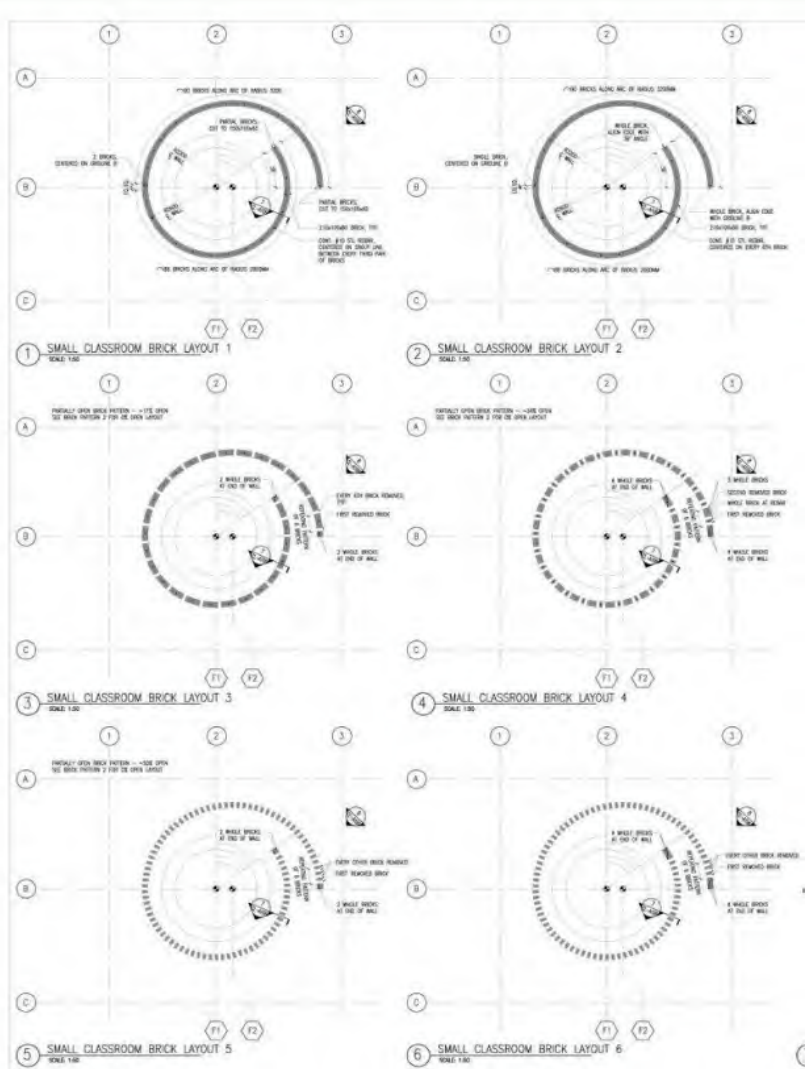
Estudo sistema construtivo salas para disposição tijolos
